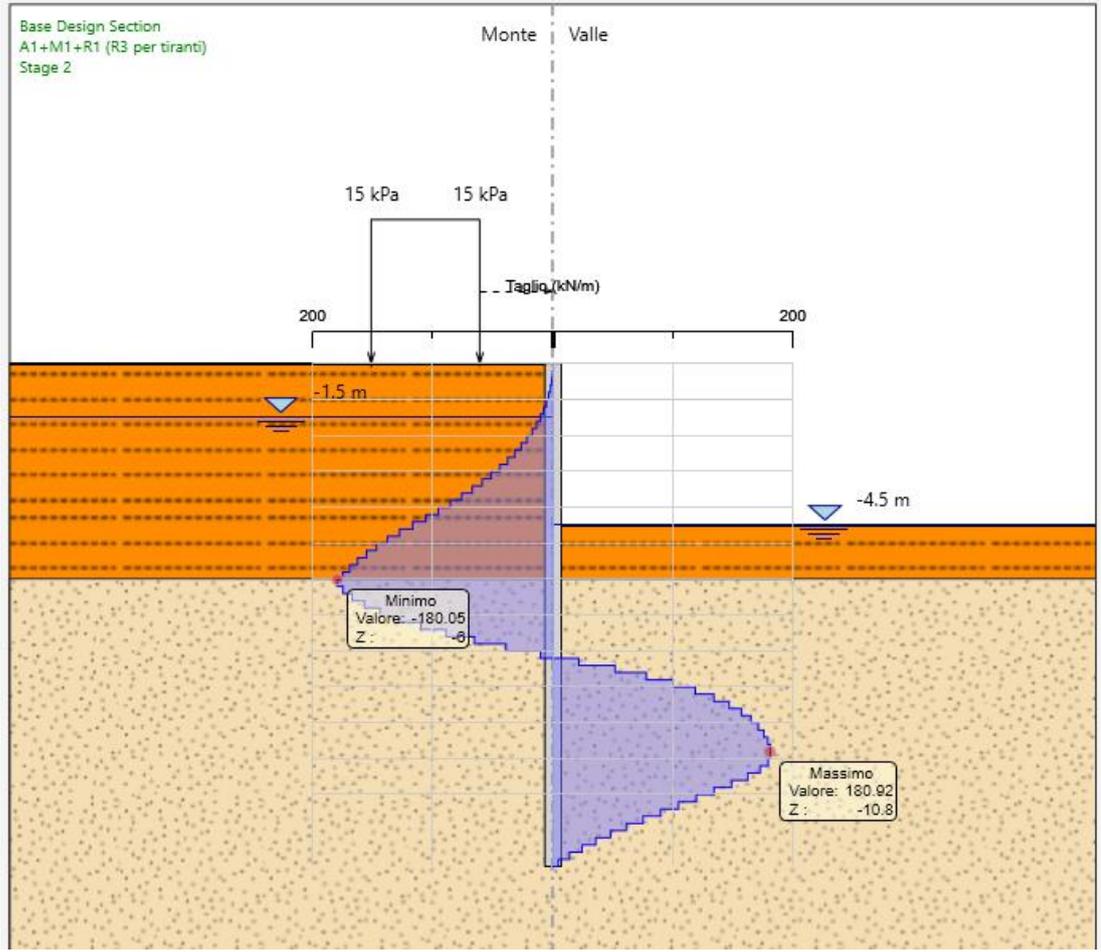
Taglio di design sugli elementi strutturali- Verifica SLU (A1+M1+R1) – kN/m
